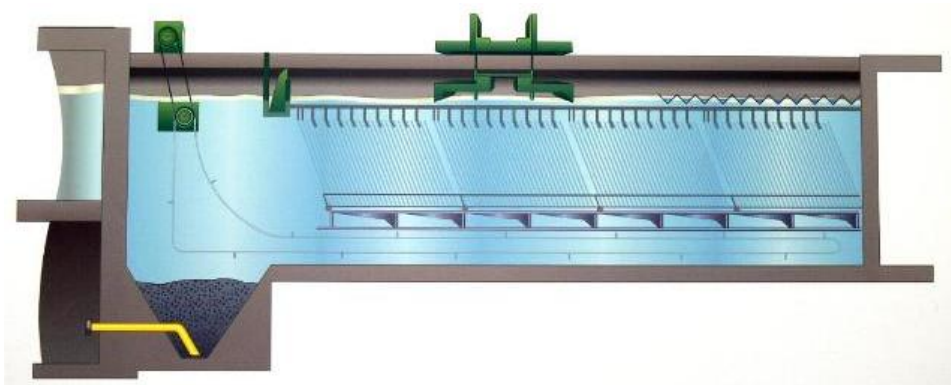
Coupe transversale d'un décanteur lamellaire (source : Ville de Québec)
